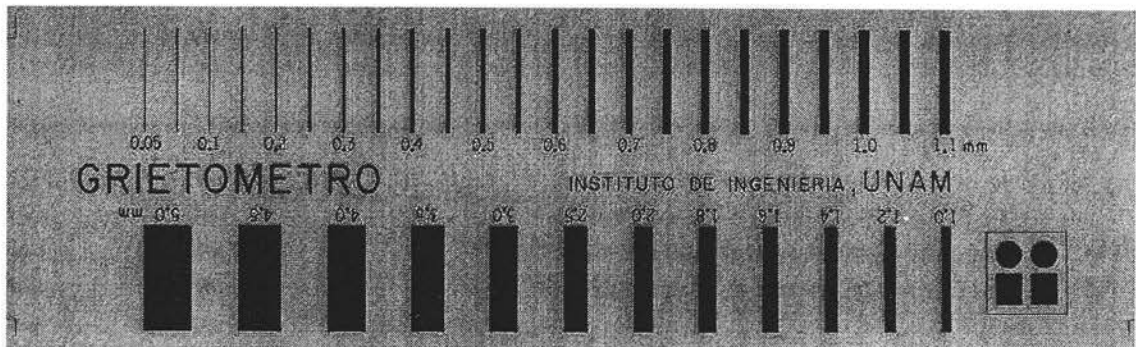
Grietómetro para medir ancho de grietas ⁴
